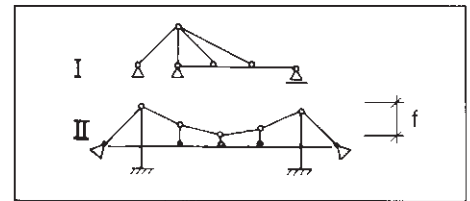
Mögliche statische Systeme: I) abgespannter Balken, Bodenverankerung mit Mast, II) Hängebrücke, im Versteifungsträger verankert
